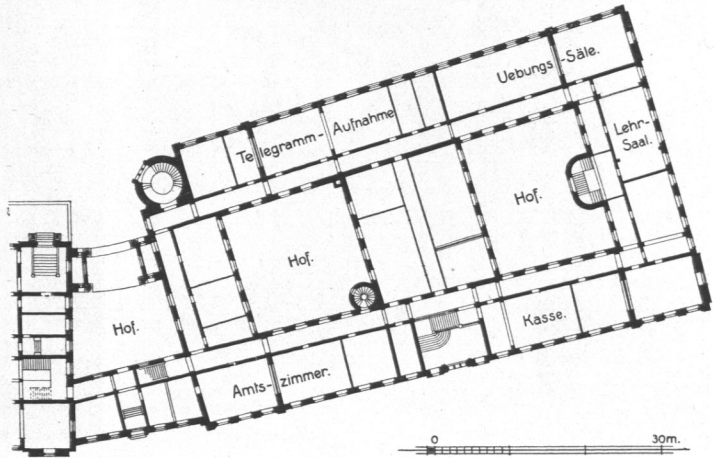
Hauptpost- und Telegraphengebäude, Telegraphengebäude, Erdgeschoß, Grundriß.
